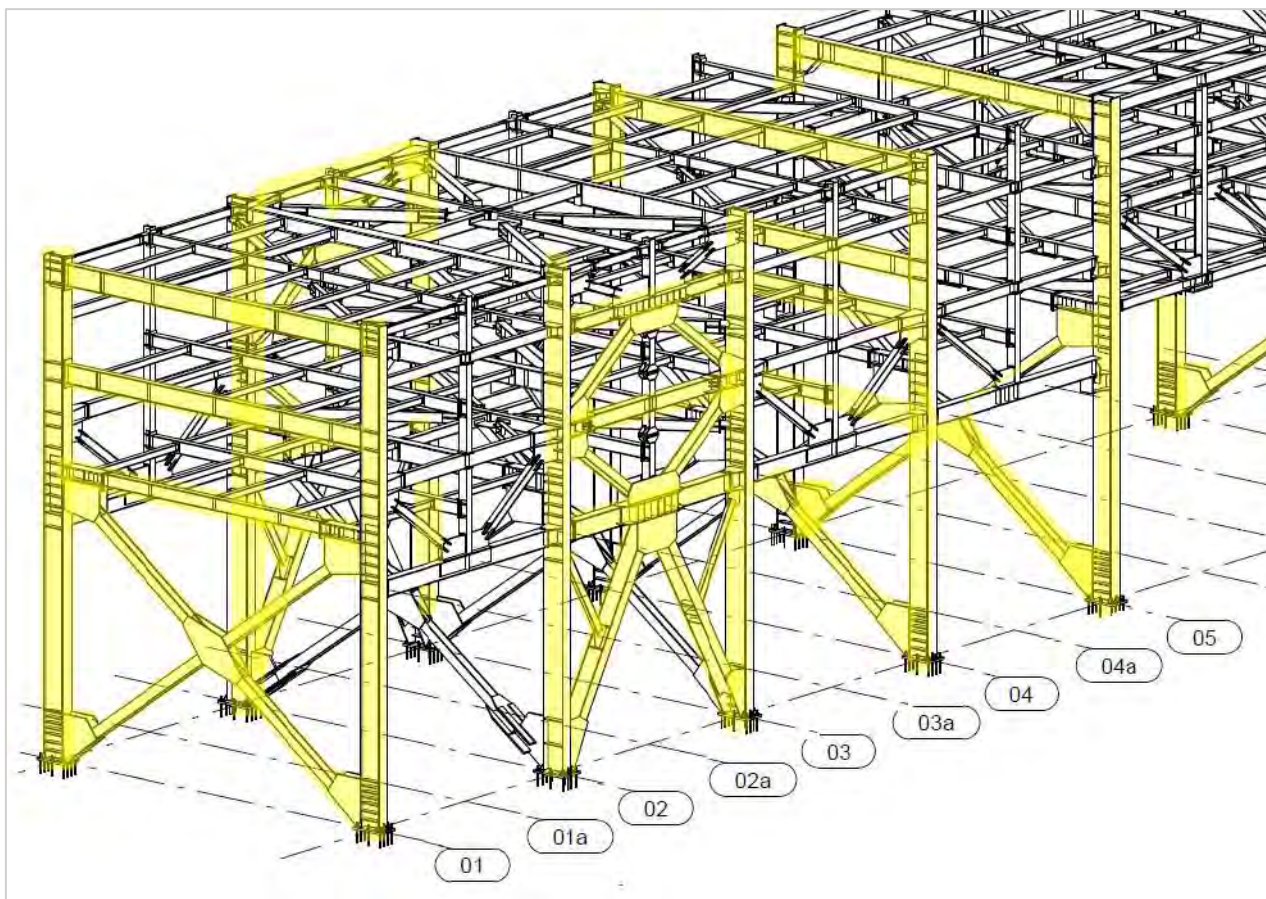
Vista de la secuencia de montaje de pre-ensambles (pórticos y alzados)
